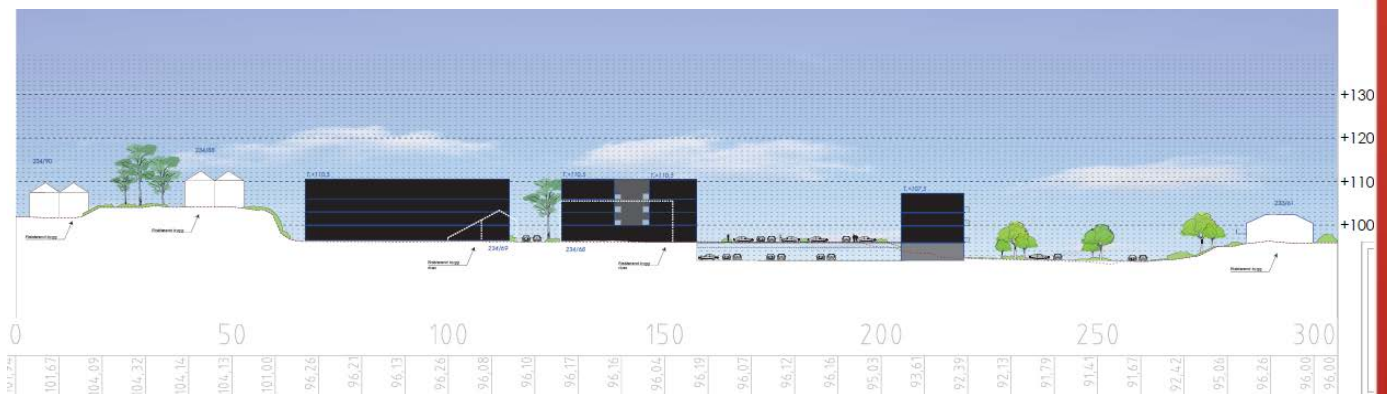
Snitt som viser volum i terrenget (ABO Plan & Arkitektur AS)
